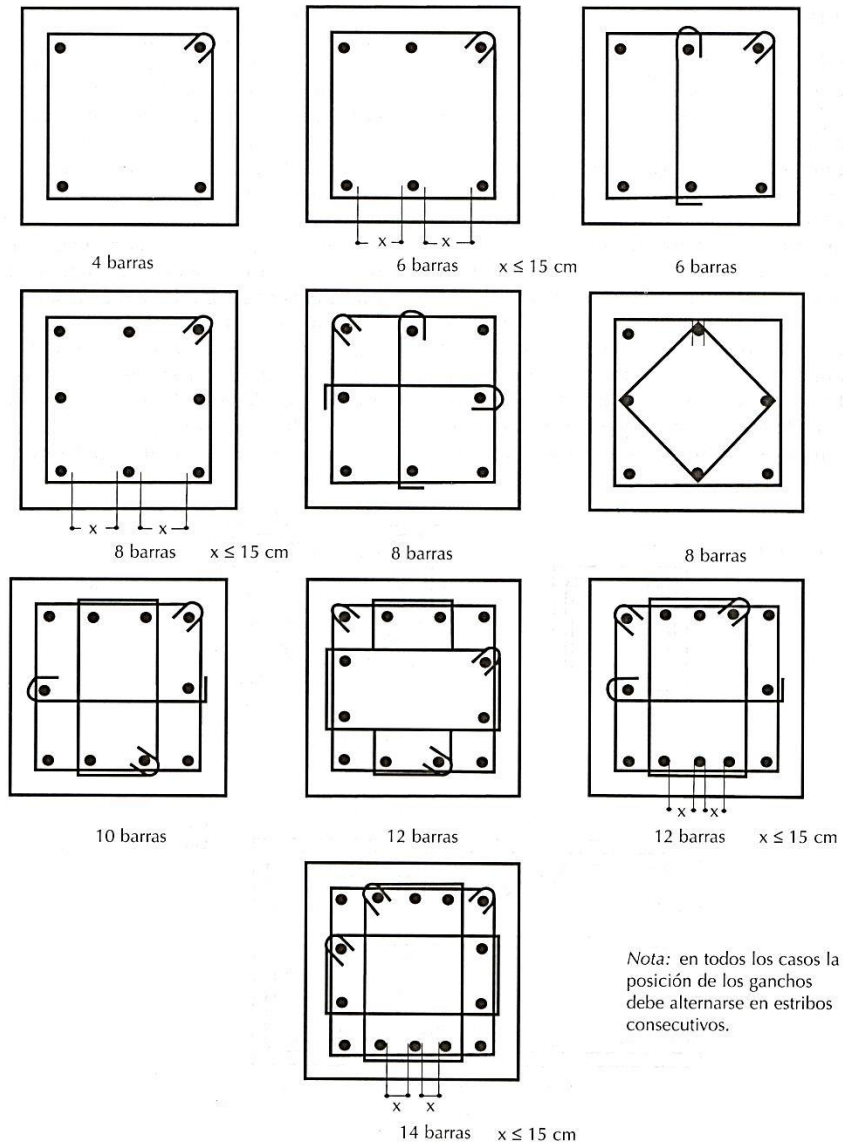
Diferente armado de estribos en secciones cuadradas.
